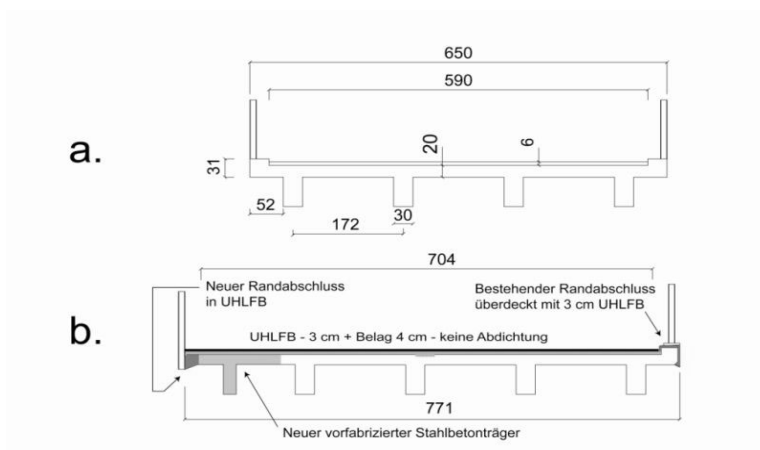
Querschnitt der mit UHPC instandgesetzten Brücke in Bild 6 [3].
